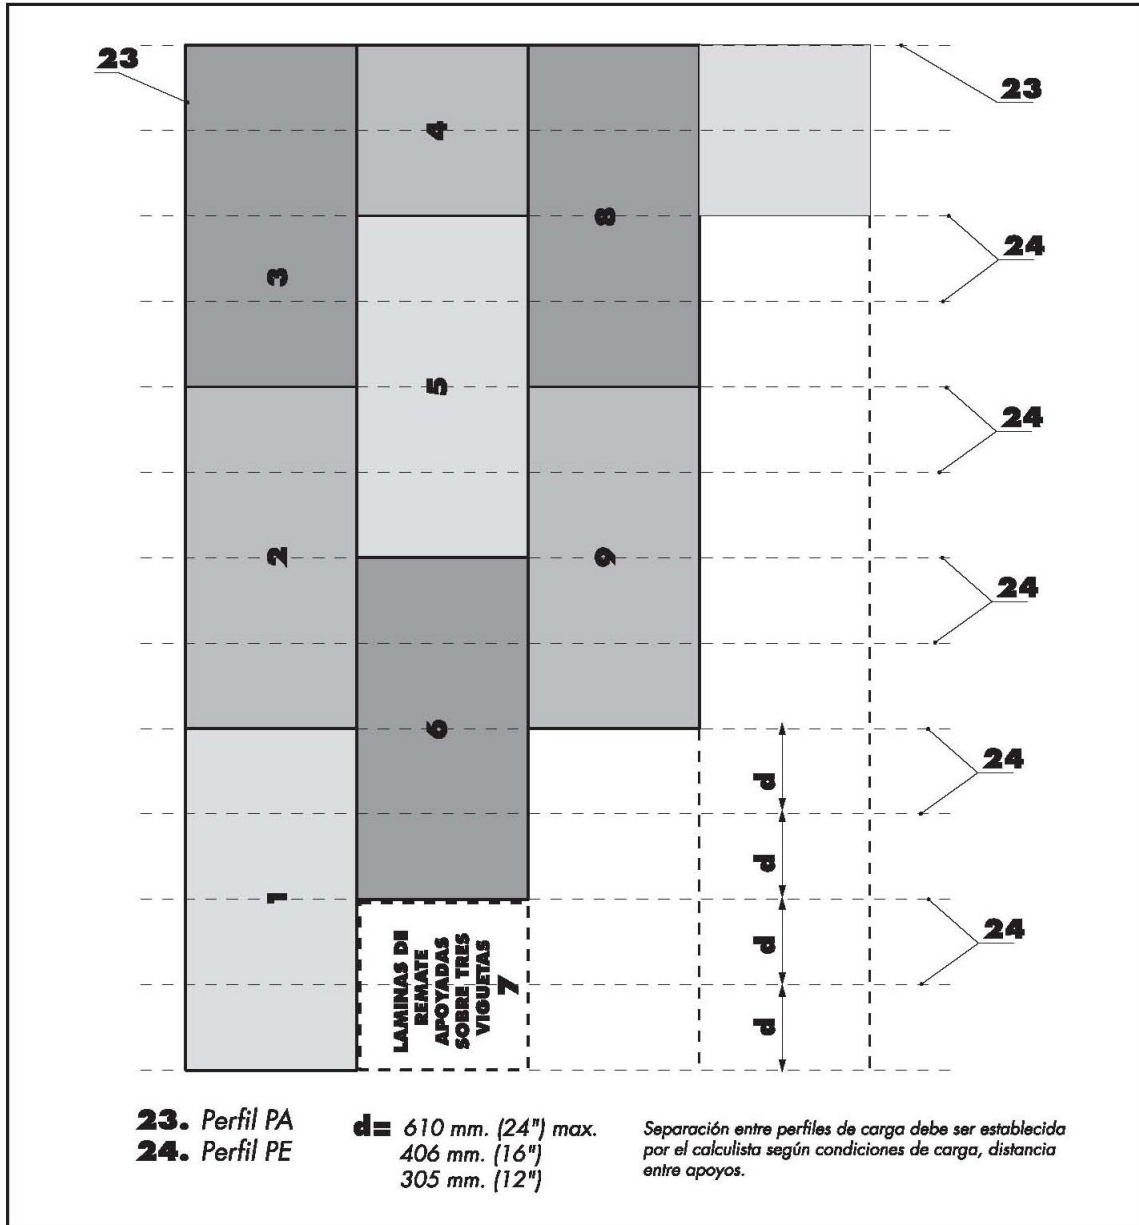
Detalle 6. Forjado. Distribución de láminas Plystone [87].
